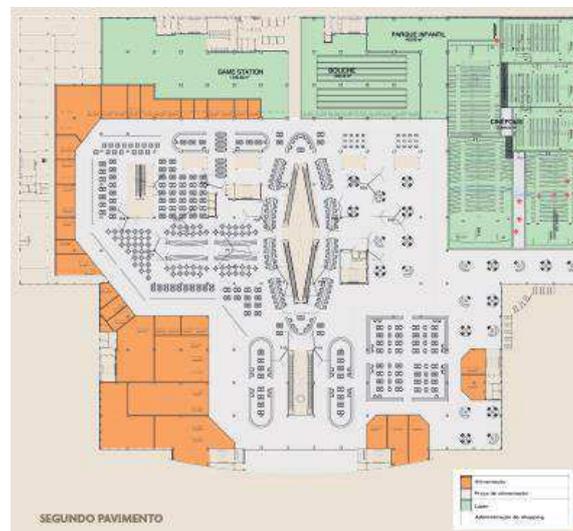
PLANTA BAIXA SEGUNDO PAVIMENTO (P3)
